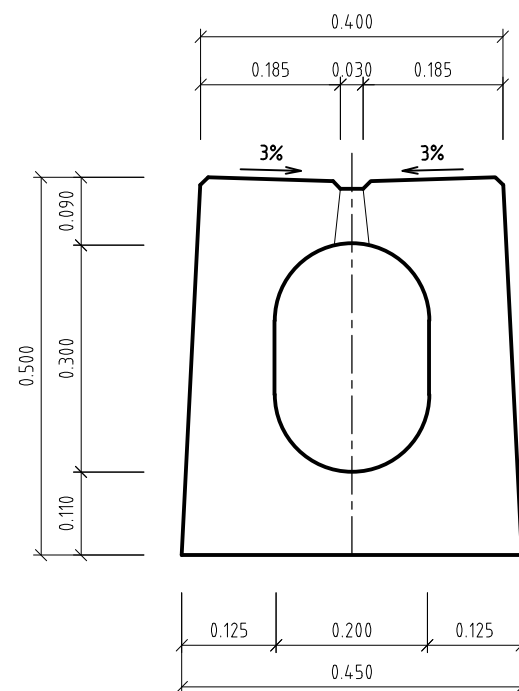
DETAIL MONOLITICKEJ ÚPRAVY PREFABRIKOVANÉHO ŽĽABU š. 0.50m V
